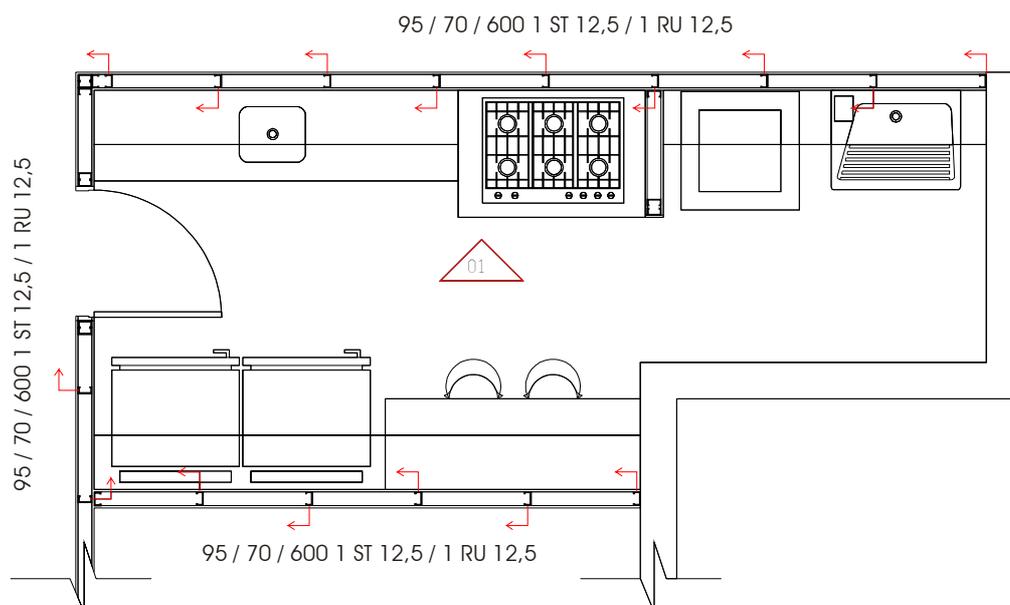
Desenvolvimento Executivo (Planta Baixa Cozinha). FONTE: Desenho da autora.
